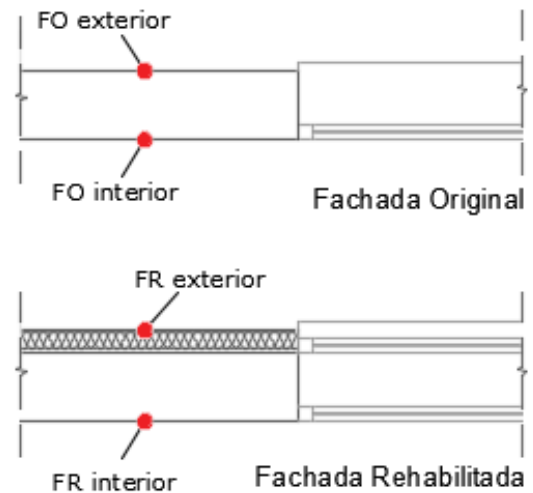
Detalle de colocación de los termopares en las fachadas. Sección horizontal fachadas tipo.
